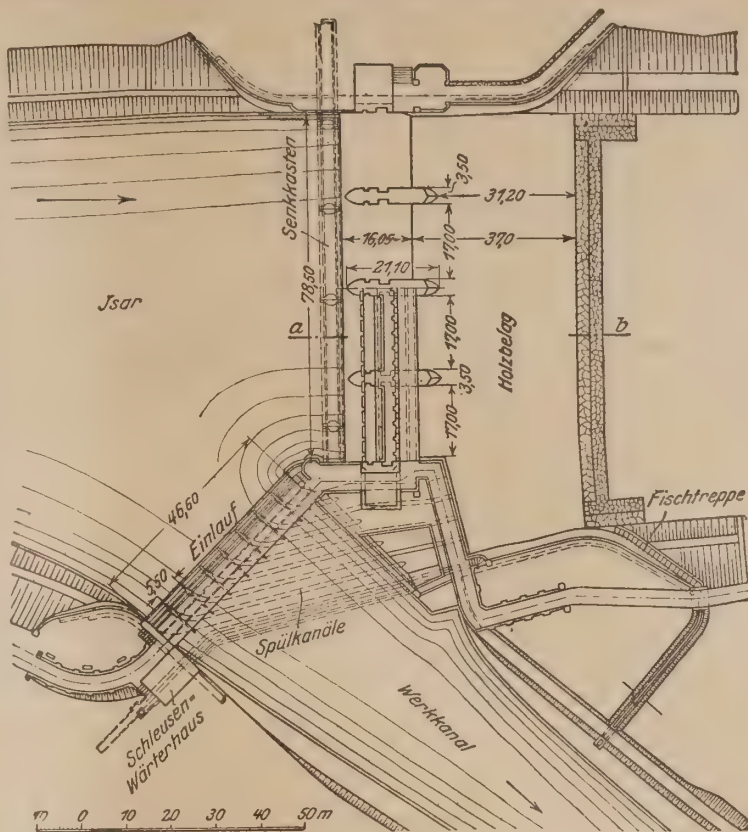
Lageplan des Wehres bei Oberführung mit Einlaufbauwerk.
